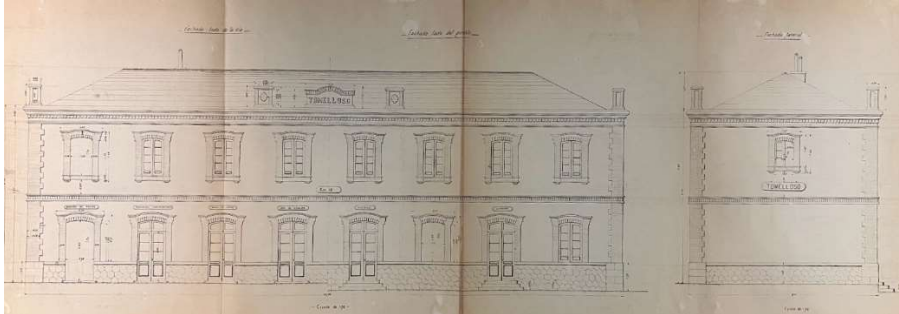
Plano con el alzado del edificio de viajeros de Tomelloso, año 1908.
